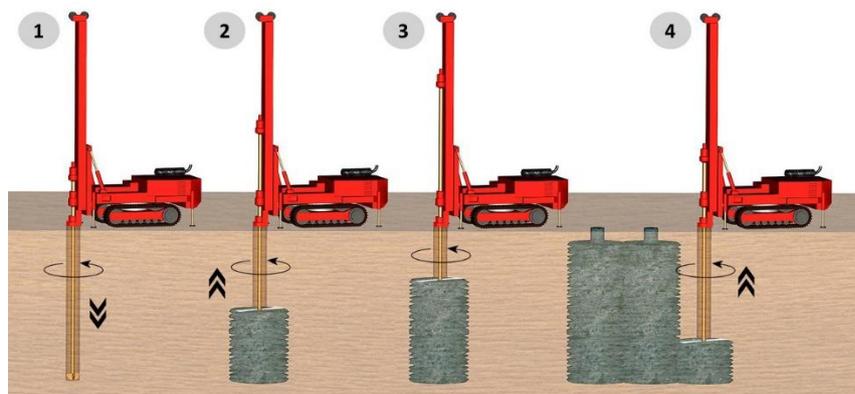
Fasi realizzative del Jet grouting (Fonte / <http://www.railsystem.net/jet-grouting/>, [02/10/2017])
